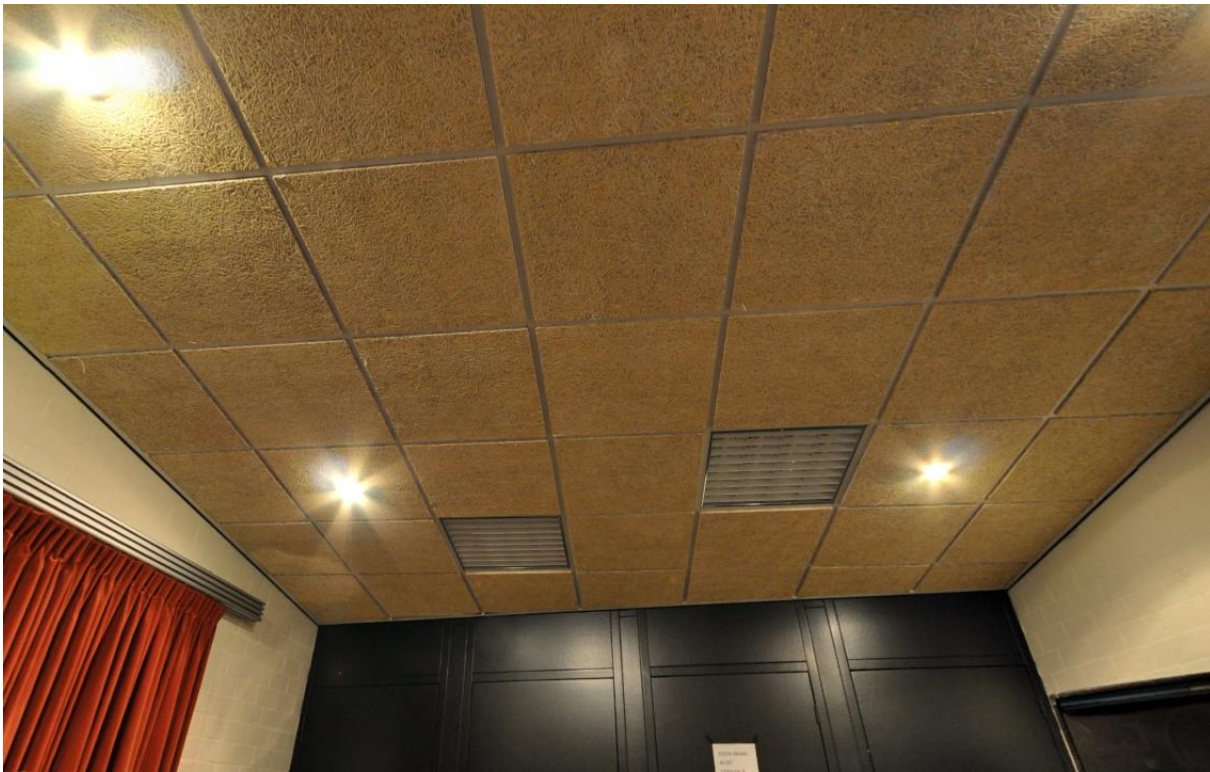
Overzichtsfoto van armaturen in studioruimtes Tavenu
